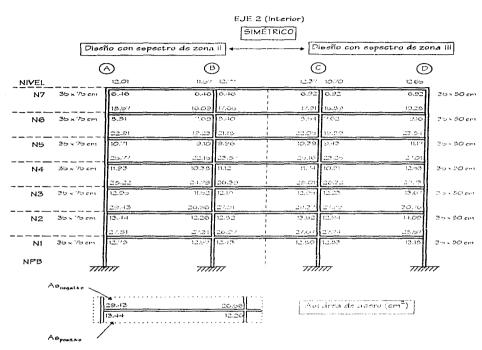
Comparación de cuantíae de acero de refuerzo longitudinal de las vigas del eje 2 de las estructuras discriadas en las zonas lí y !!!
